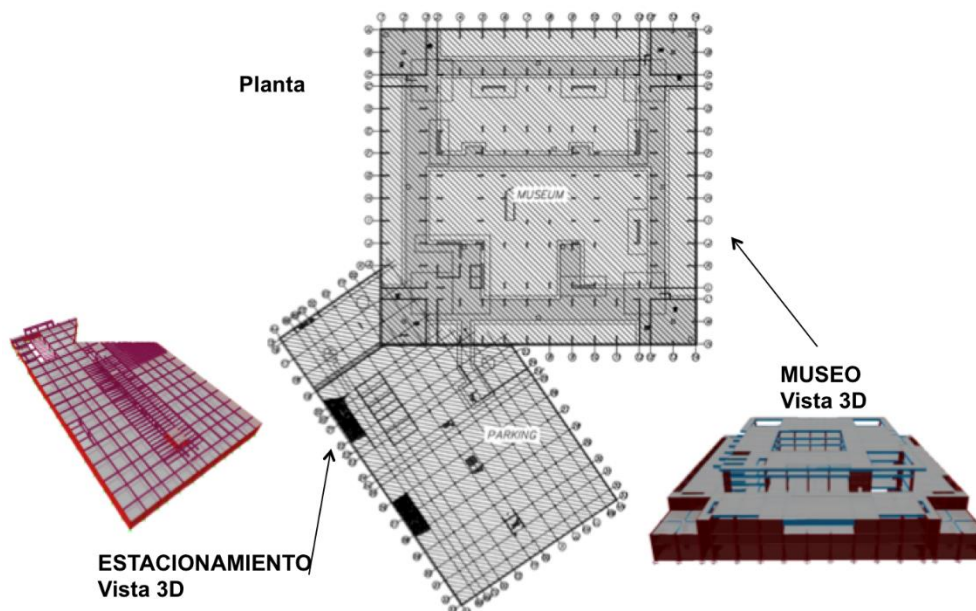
Vista em Planta e 3D do museu e parque estacionamento.
